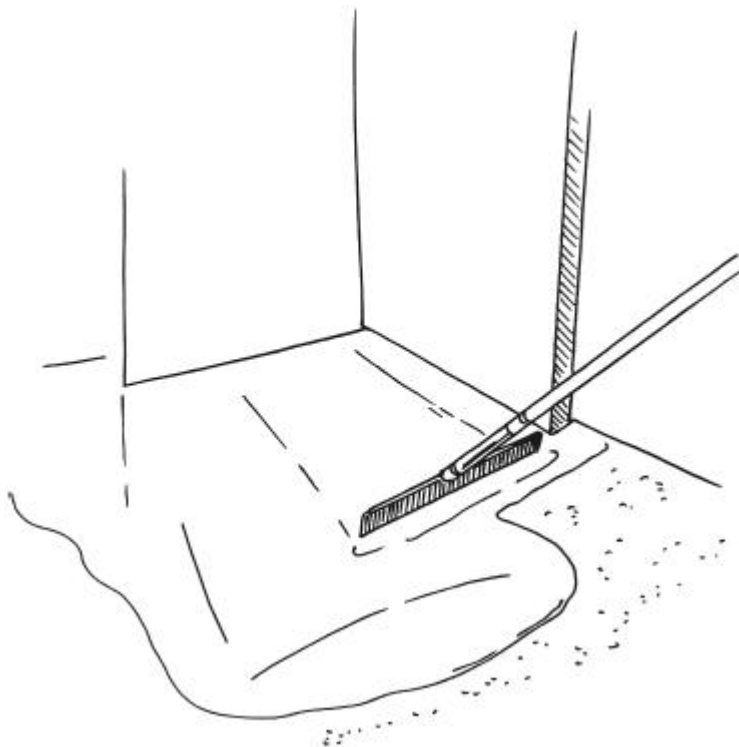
Выравнивание нанесенного слоя литой гидроизоляции
